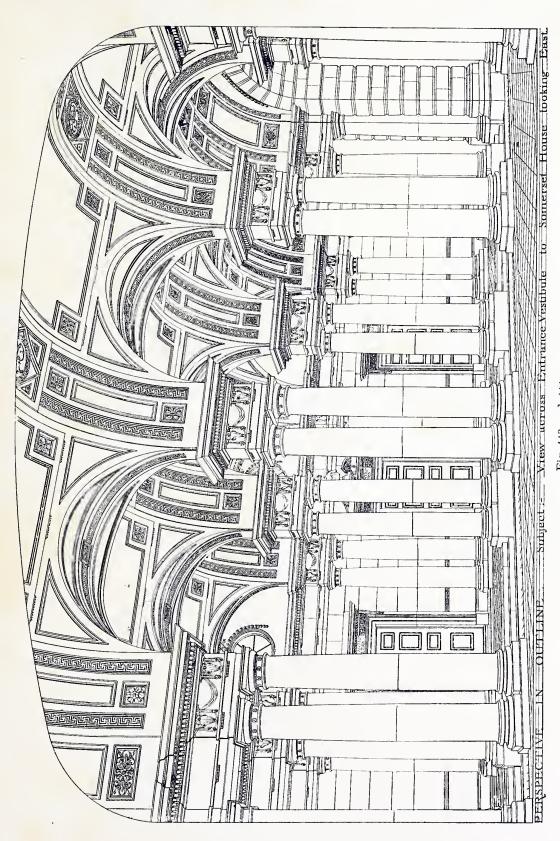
und 444. Eingangshalle vom Somerset-House in London (n. Building News).
